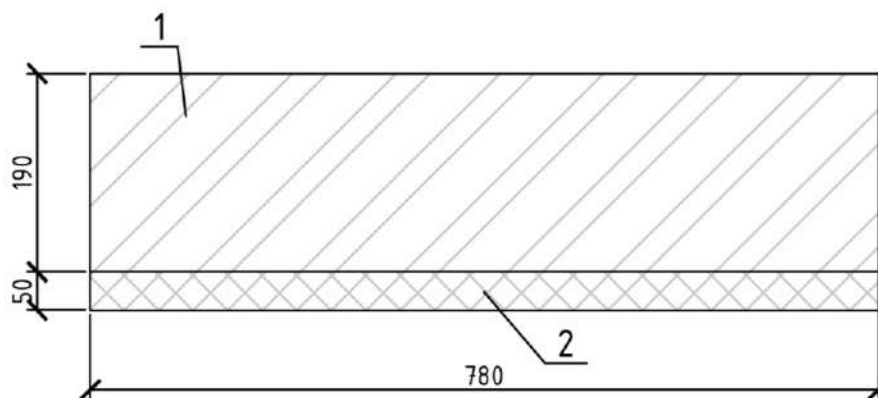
Схема сечения стены по кладке с 50 мм утеплителя без дефекта.
